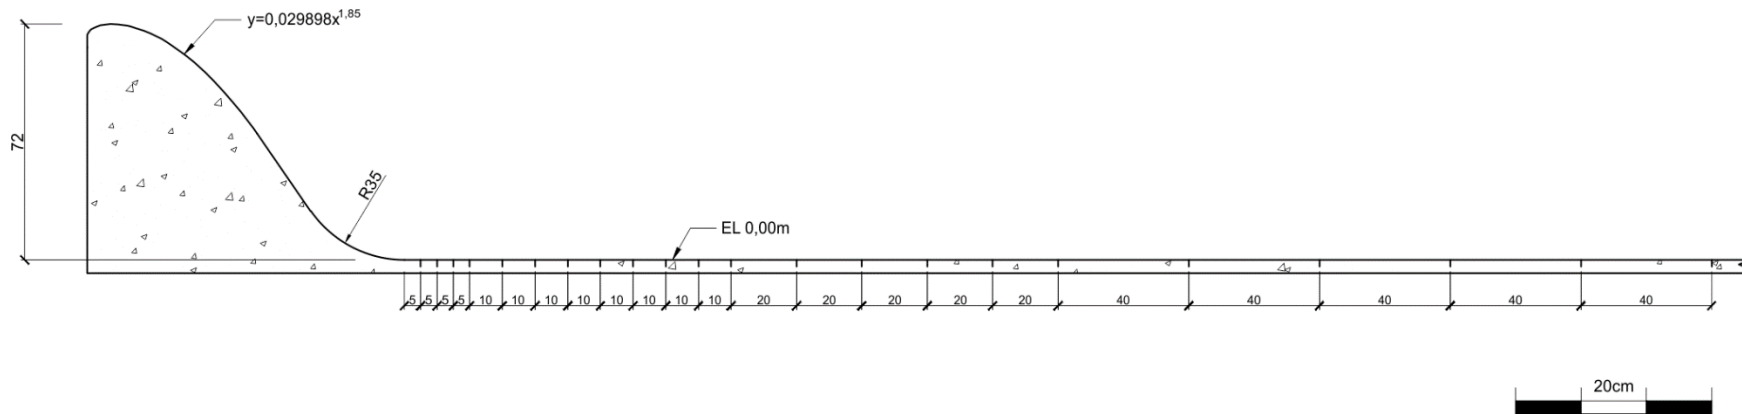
Perfil longitudinal do modelo utilizado e posição das tomadas de pressão. Fonte: Marques (1995).
